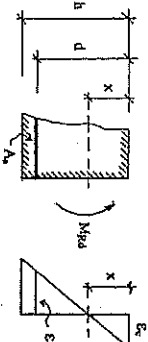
Flexão normal simples de uma viga de concreto armado
